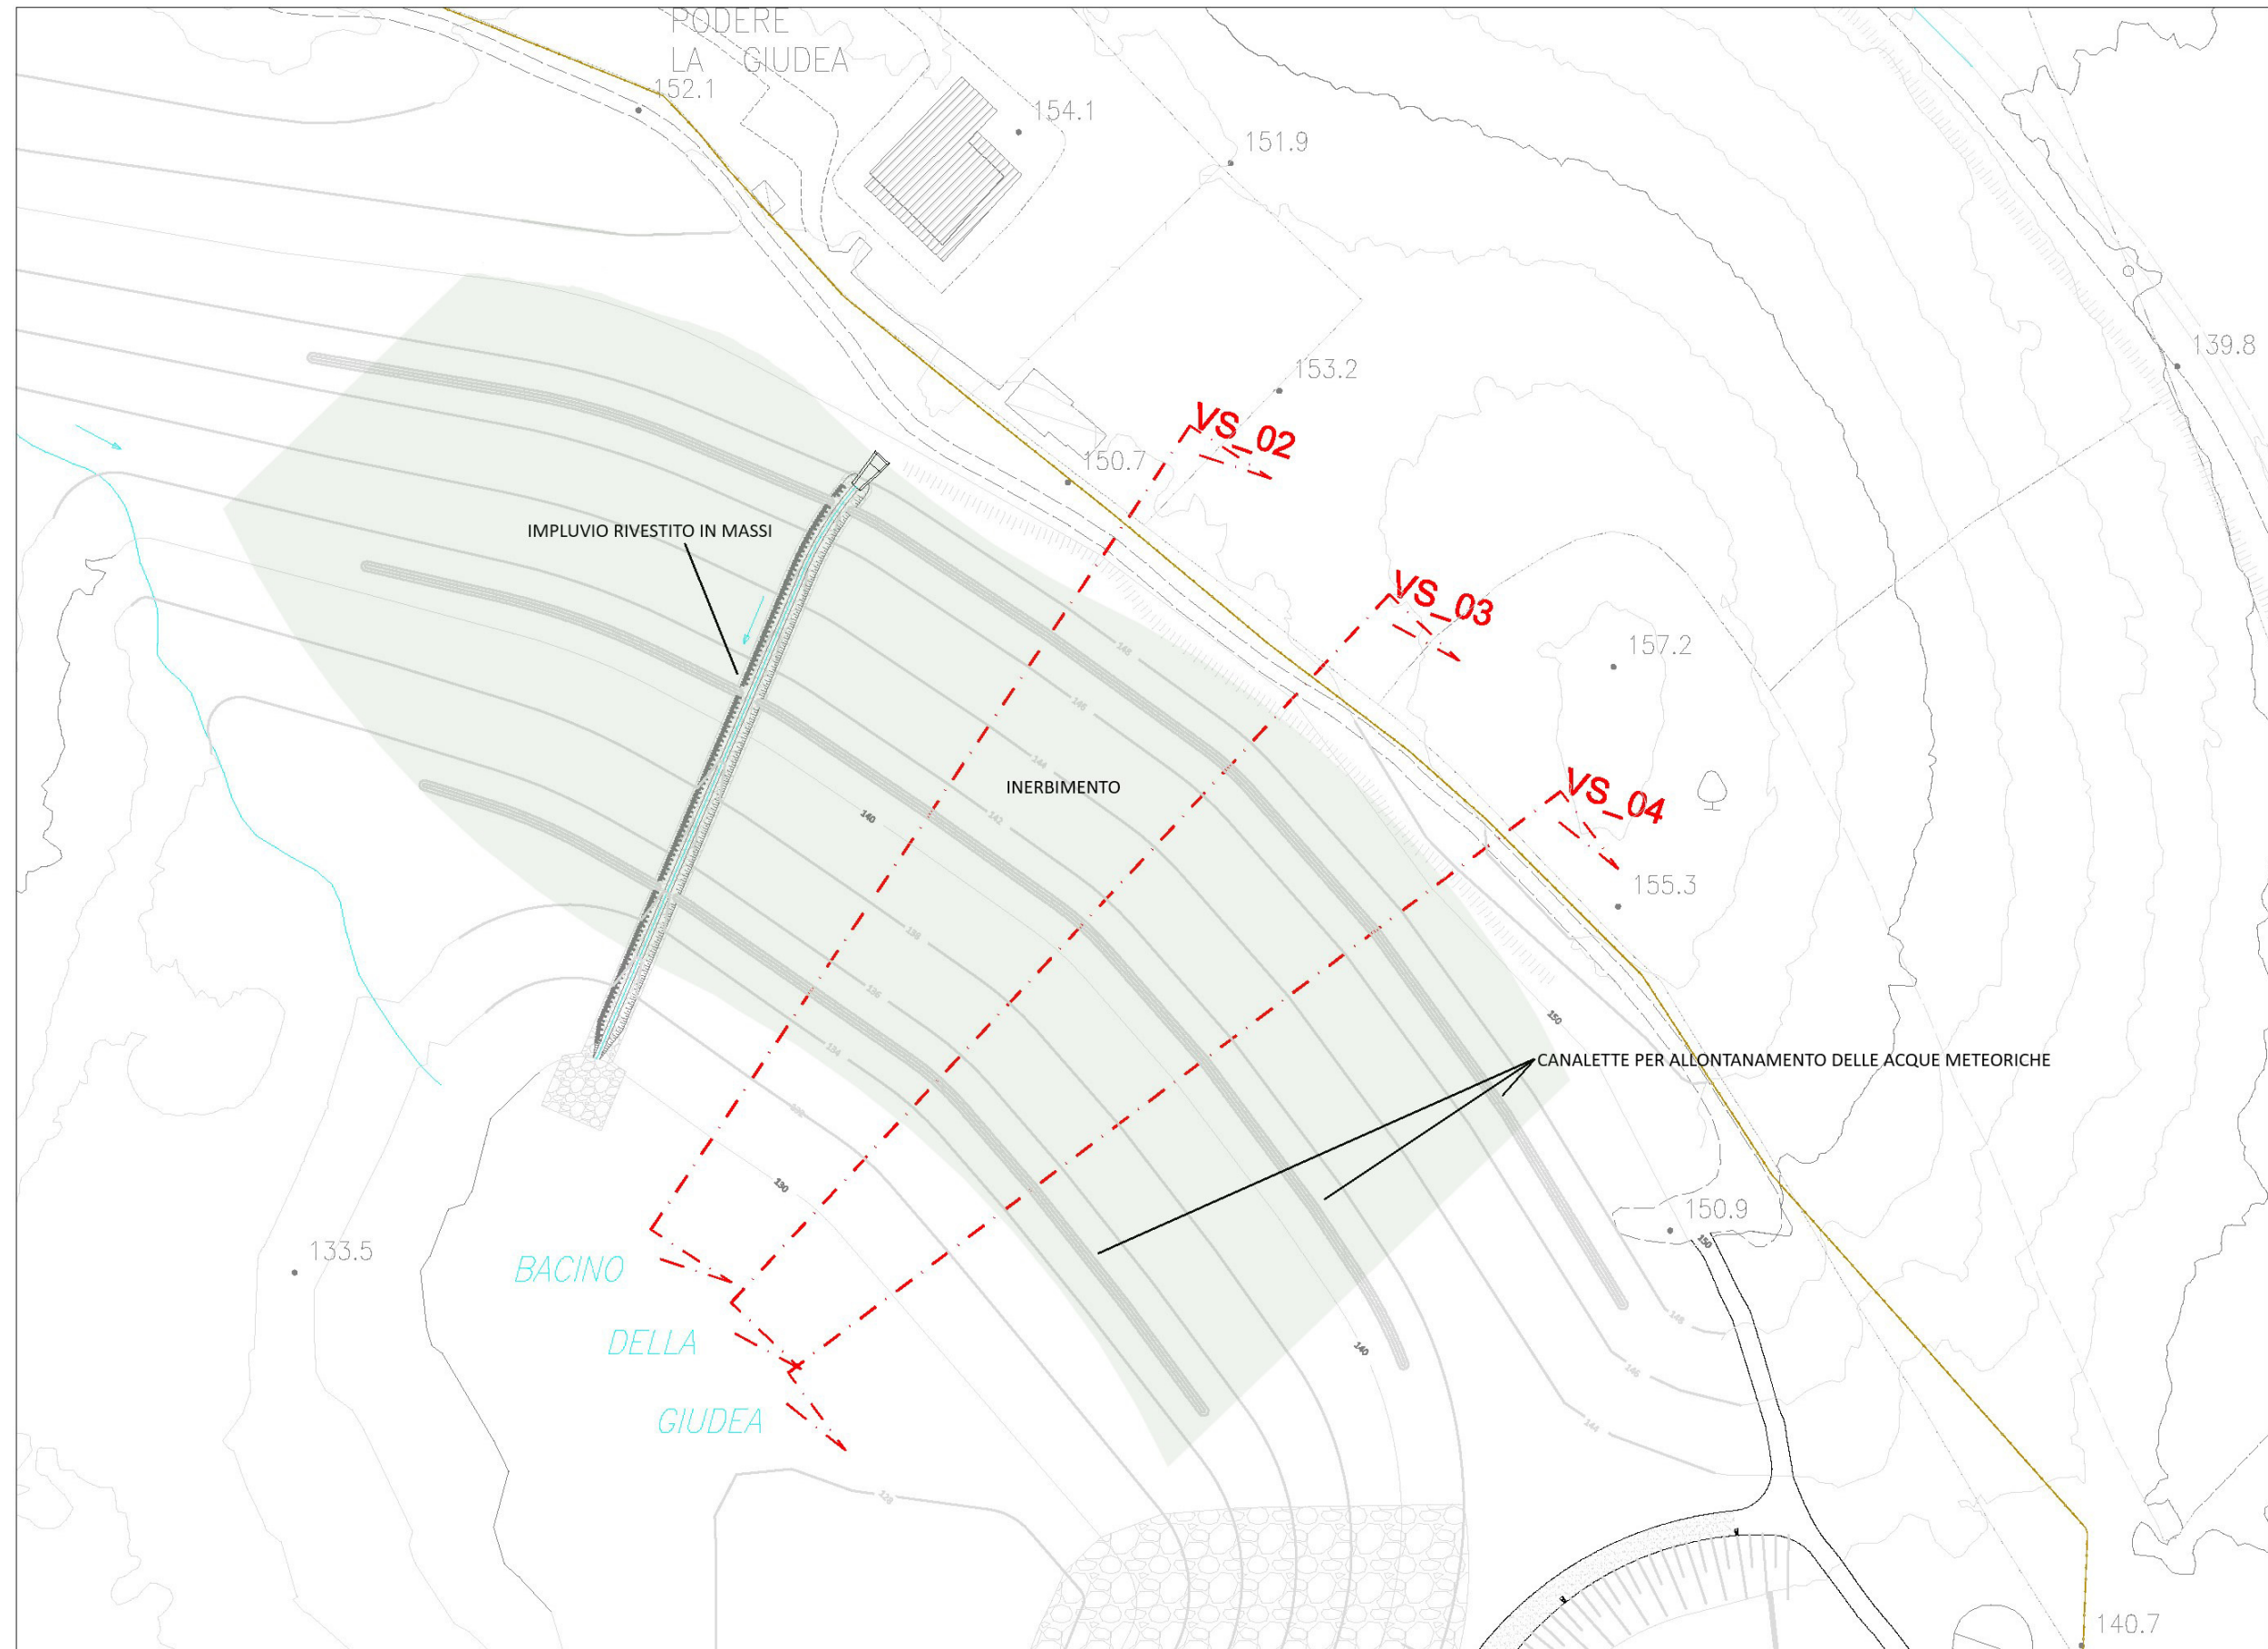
Planimetria degli interventi in sponda sinistra
